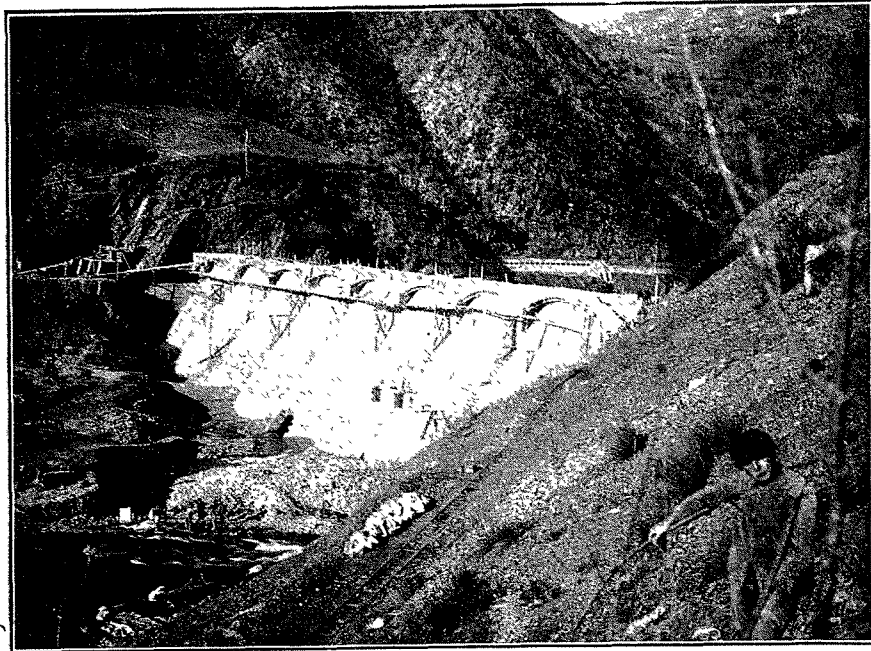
Vue générale du Barrage du Riolunato prise, pendant la construction de l'ouvrage, à l'achèvement des voûtes.
